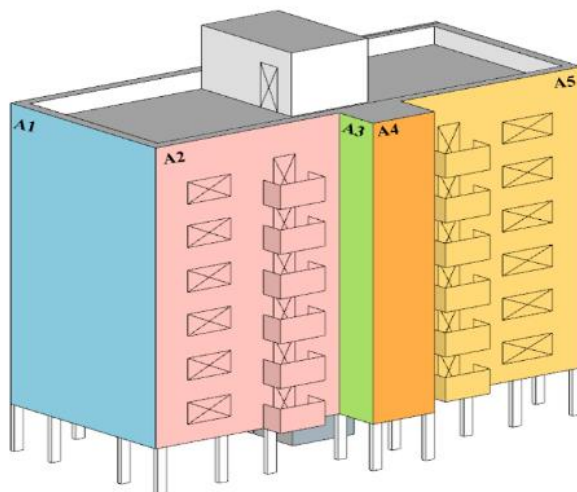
Divisão da fachada em amostras (PIAZZAROLLO, 2019).
